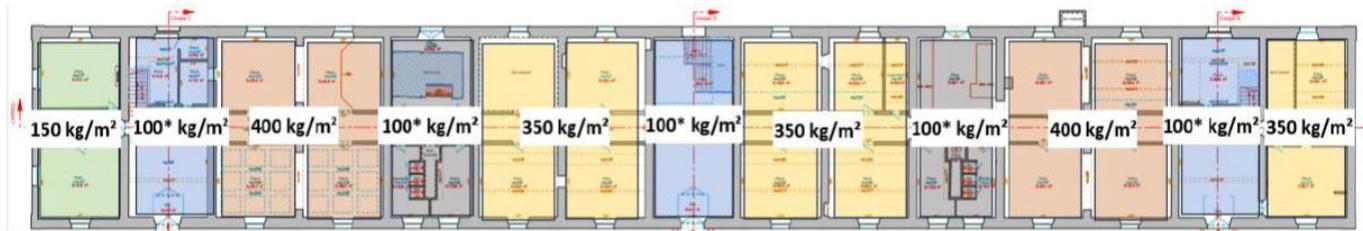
charges admissibles sur le plancher haut du RDC soit le plancher bas du R+1
